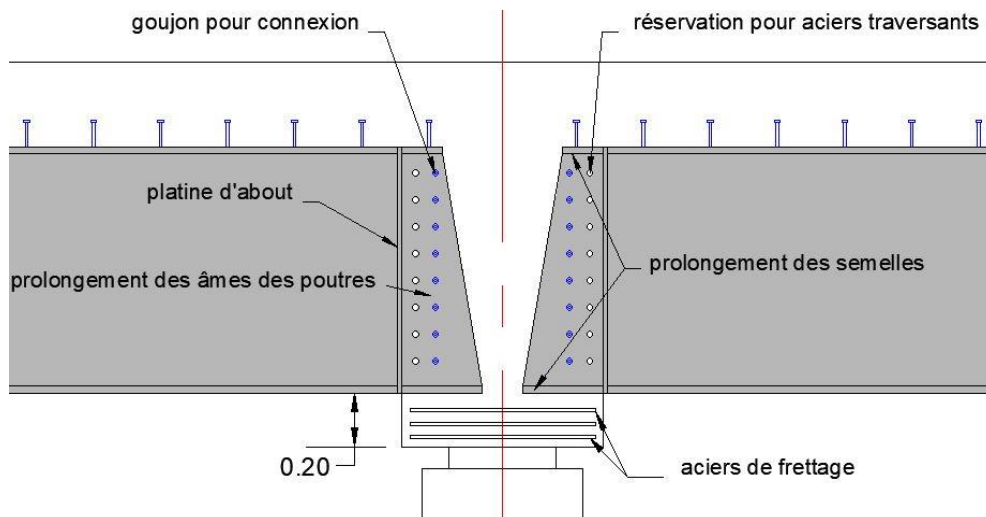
Proposition d'adaptation de la connexion poutre-caisson / entretoise béton retenue pendant la mise au point du marché
